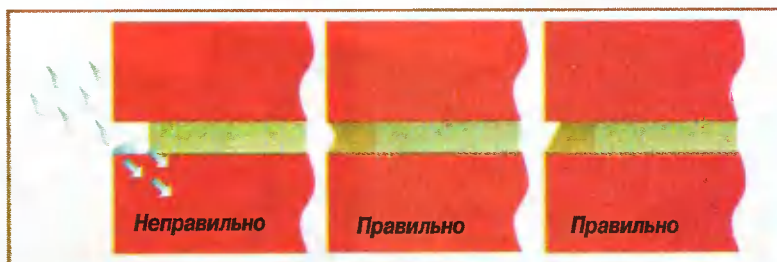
При выполнении облицовочной кладки особое внимание следует уделить расшивке швов. При неправильно сформированном шве может произойти скопление в нём воды с возможным её замерзанием и разрушением кладки. Если швы выполнены правильно, вода будет стекать вниз.
